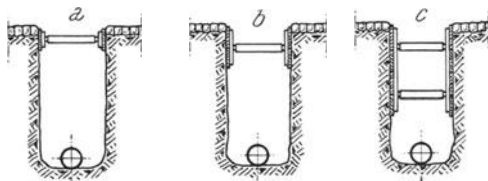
Rohrgrabenpöhlungen. (Nach P. Brinkhaus)
